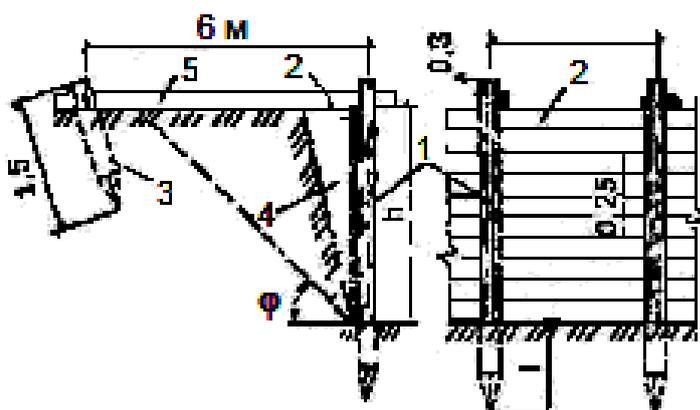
Консольное крепление стен траншей и котлованов для прокладки ПВТНК из ВЧШГ
